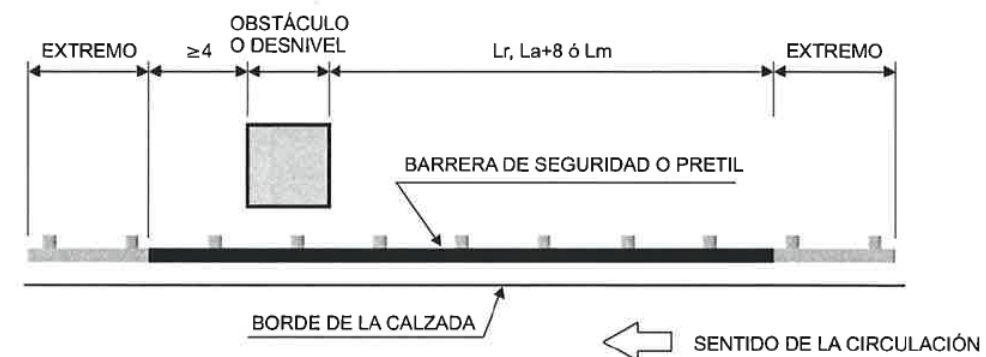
Prolongación de la terminación en las carreteras de calzada única o en calzadas con carriles reversibles.
